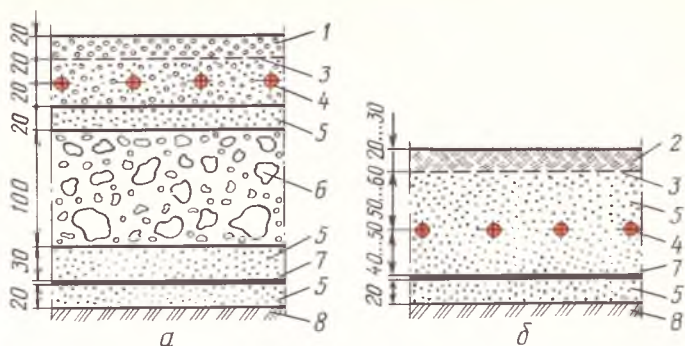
Конструктивные схемы электрообогреваемых полов: а — бетонный пол; б — глинобитный пол; 1 — бетон; 2 — глиносломенная смесь; 3 — сетка-экран; 4 — нагревательный провод; 5 — песок; 6 — теплоизоляция; 7 — гидроизоляция; 8 — грунт.
